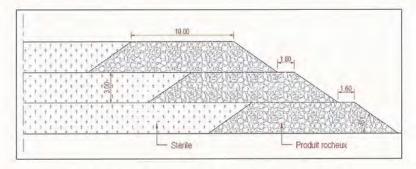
Schéma conceptuel pour la construction d'un niveau de 9 m
